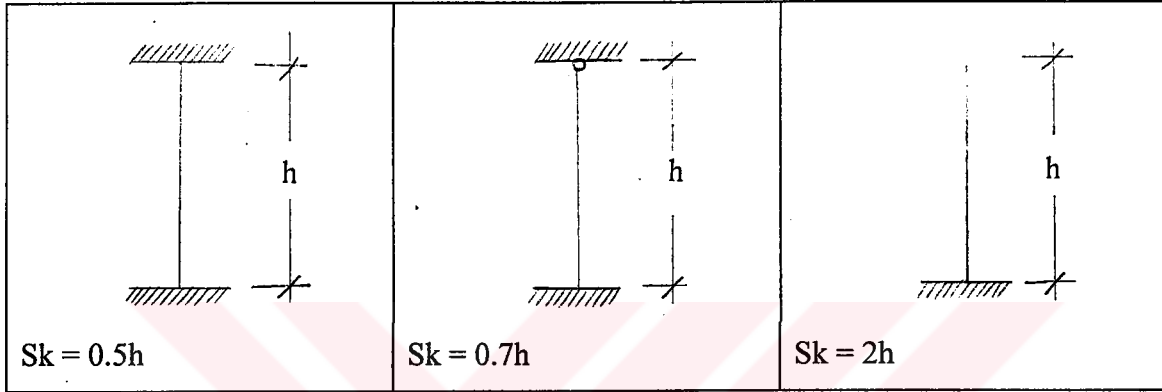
Seçilen örneklerde genellikle kullanılan kolon tipleri.
